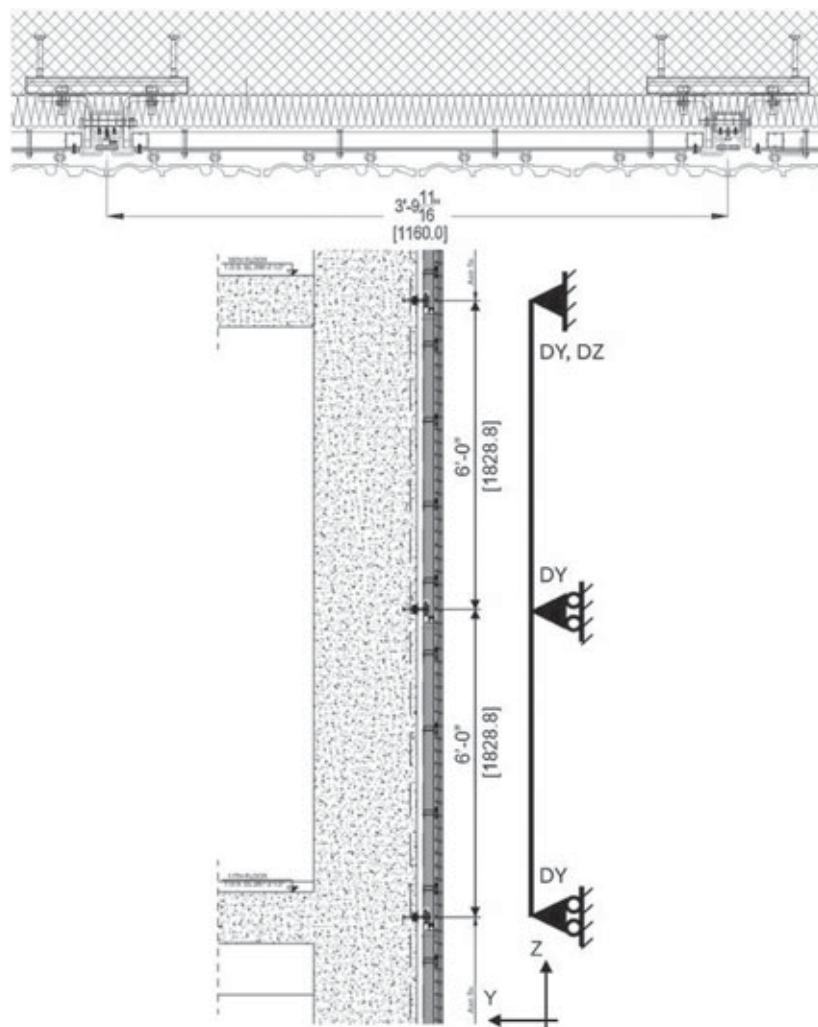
| EWS-02: sezione orizzontale e sezione verticale con schema statico per azioni fuori dal piano
